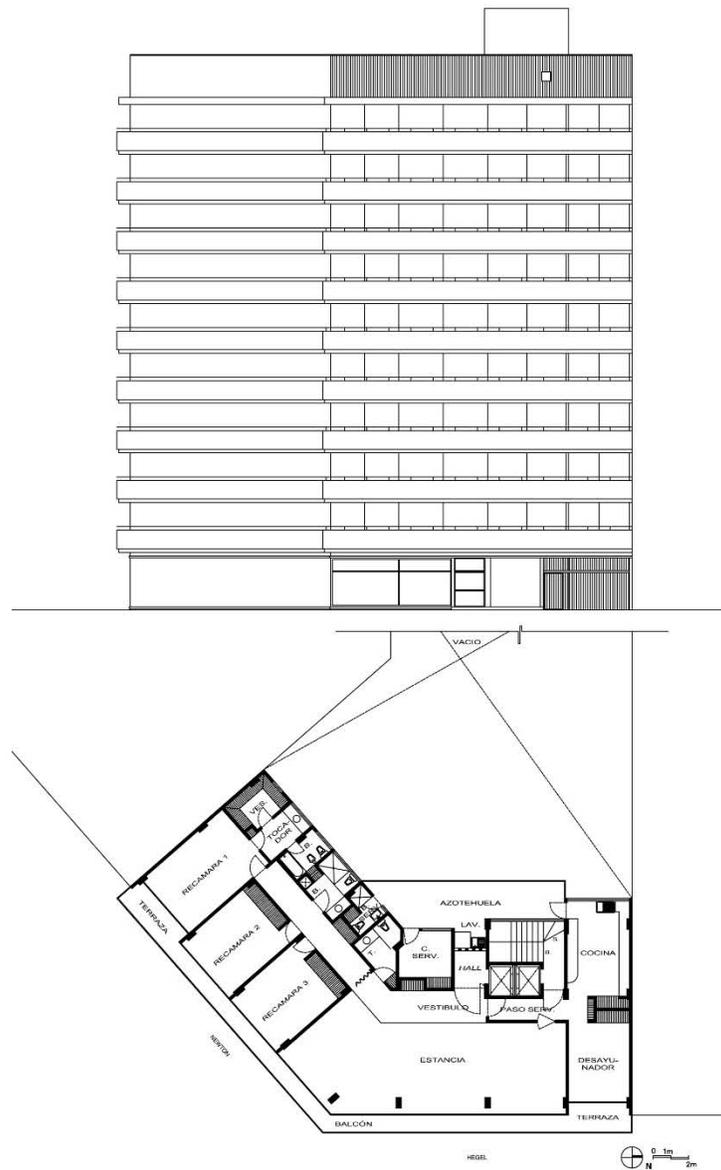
Fachada y planta del edificio ubicado en Hegel núm. 237
